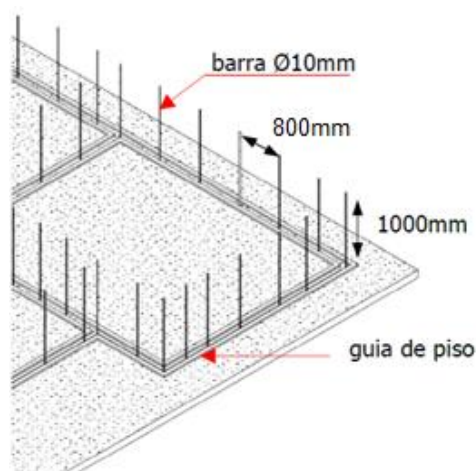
Ilustração da ancoragem entre parede e fundação. (Sem escala).
